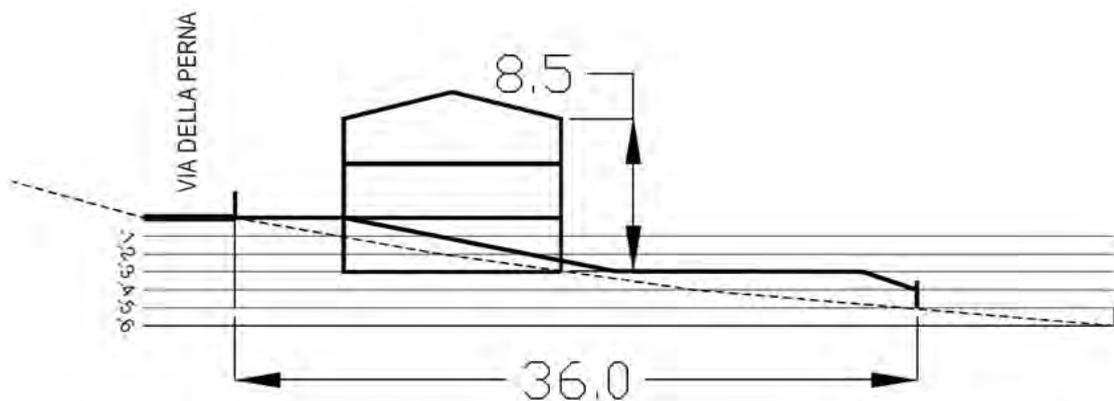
Sezione tipo dell'inserimento di un edificio nell'area edificabile.
